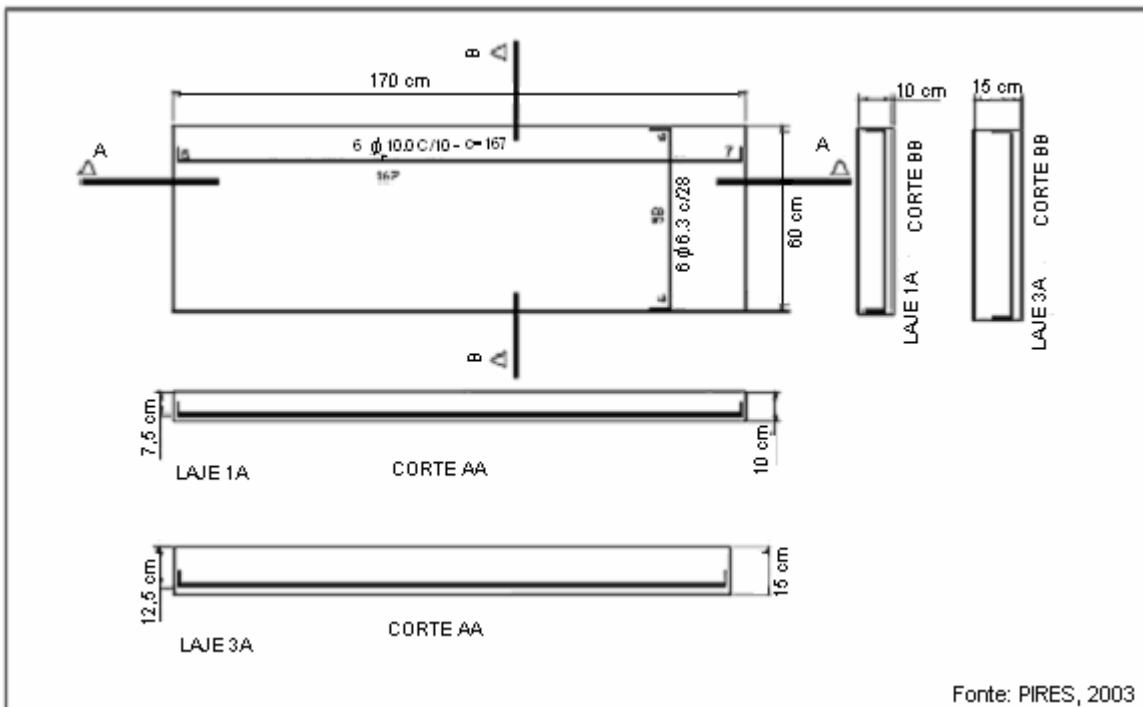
Dimensões, detalhamento das armaduras e apoios das lajes ensaiadas por Pires (2003)
